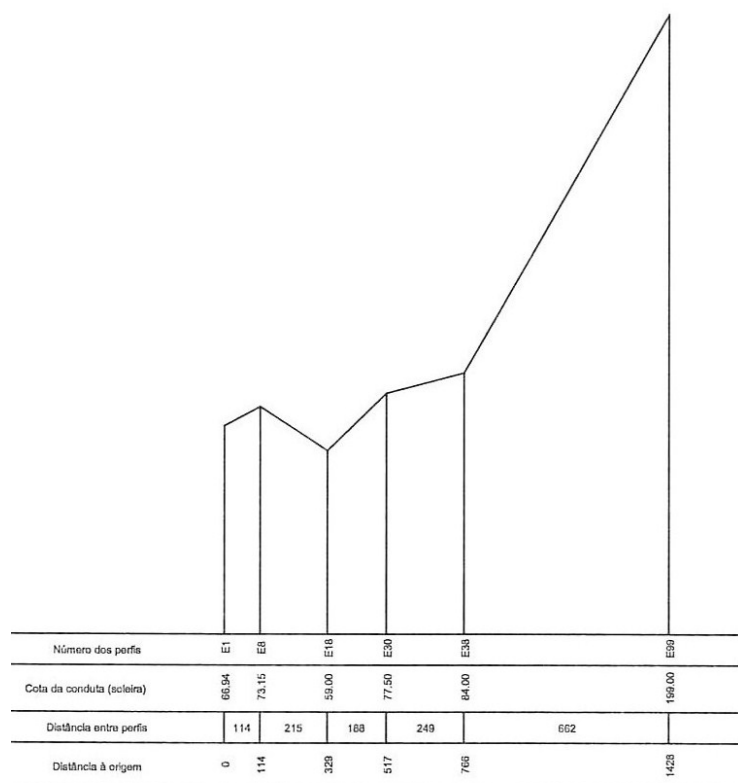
Representação do Perfil Longitudinal da Conduita Elevatória
